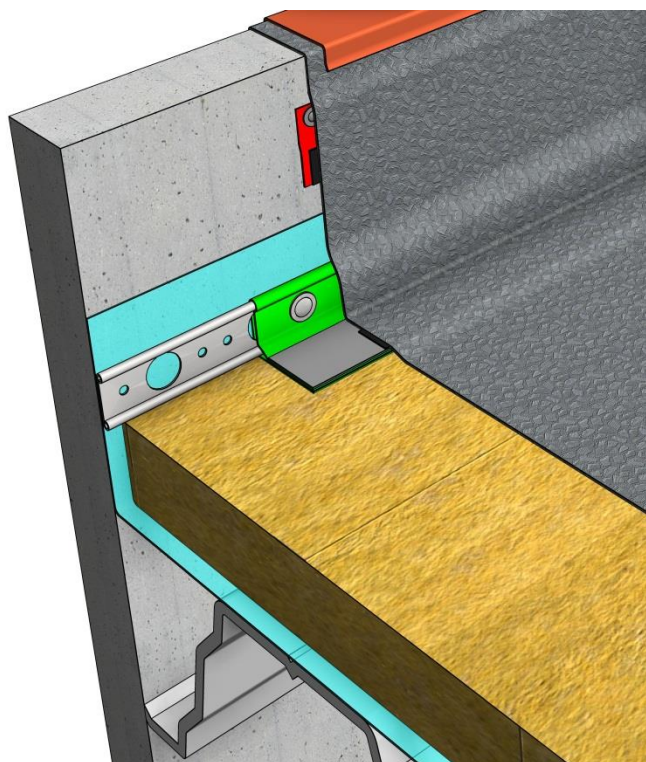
Kimfixatie met Secret Fix Pocket + Secret Fix Strip systeem (opstanden hoger dan 600 mm)
